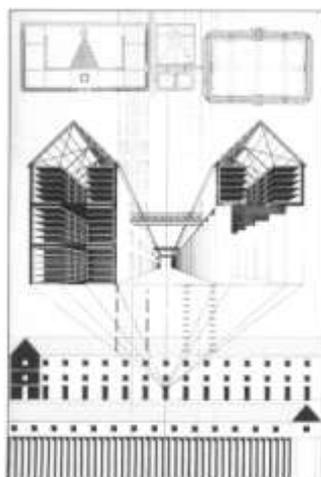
“Corte transversal do edifício do columbário e da colunata”, ligação feita por pontes metálicas no último piso, Aldo Rossi. ([Adaptado a partir de : ] Arnell, Bickford, 1985, p. 96)
